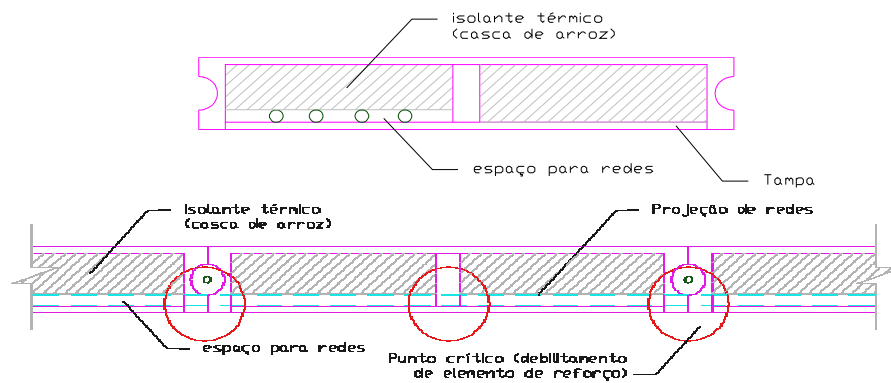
Posicionamento das tubulações de redes na vertical (acima) e horizontal (embaixo) para a primeira alternativa de sistema construtivo.
